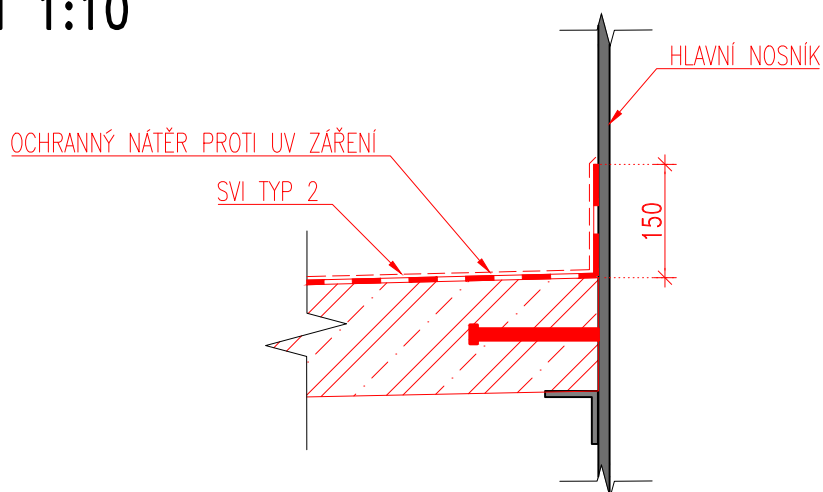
## DETAIL C: UKONČENÍ IZOLACE U HRANY ŽB ŘÍMSY
